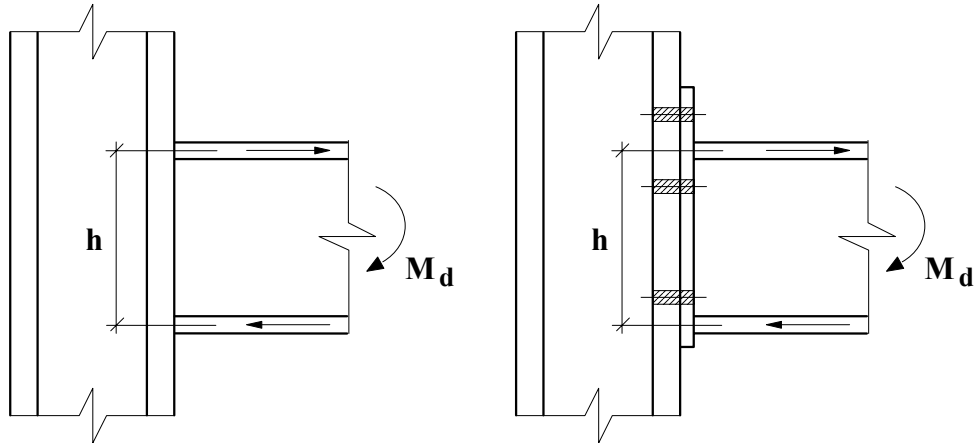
Braço de alavanca h , ligação soldada ou parafusada [8]
